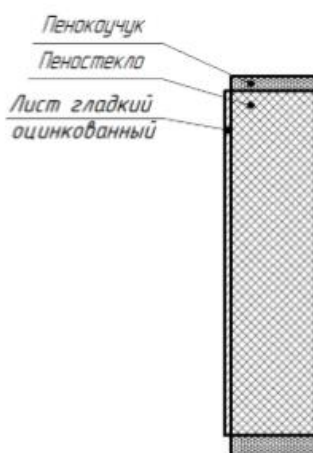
Общий вид быстросъемного элемента изоляции уторного шва стенки резервуара [9]
